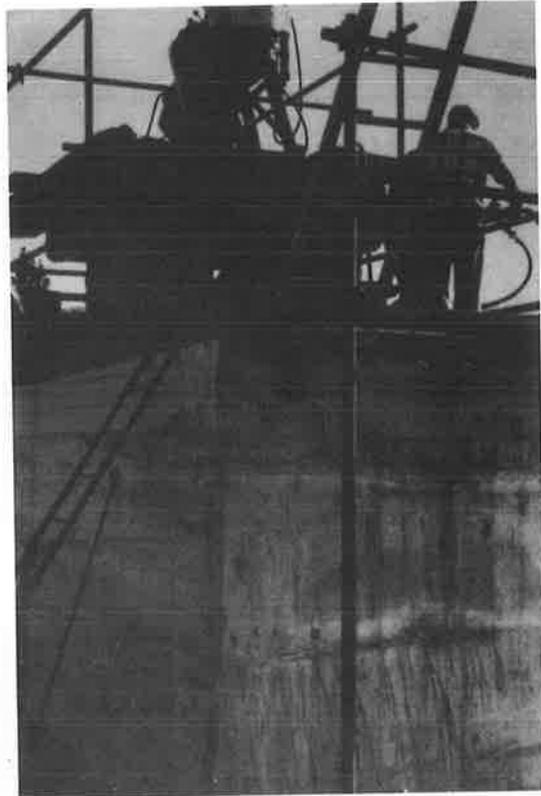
Blocco del calcestruzzo gettato in subacqueo e sollevato per le prove di permeabilità in corrispondenza delle riprese di getto.
